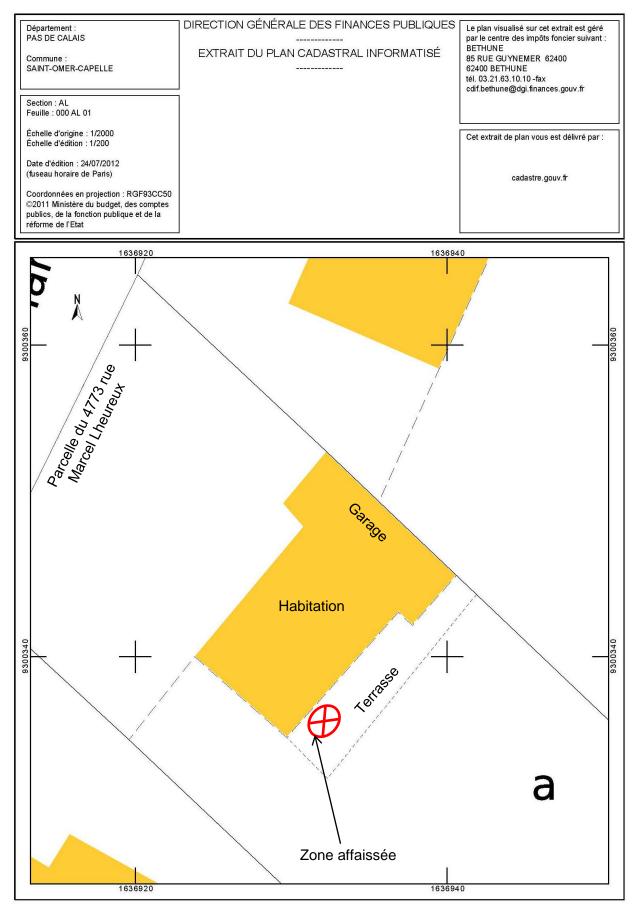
Localisation des désordres sur les bâtiments sur plan cadastral (fond de carte extrait du site <a href="https://www.cadastre.gouv.fr">www.cadastre.gouv.fr</a>)
